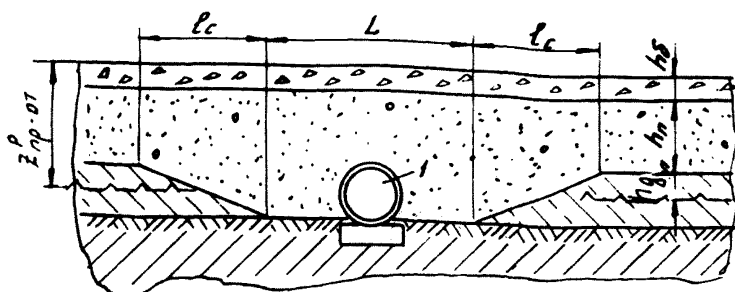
Схема устройства сопряжений насыпи из пучинистых грунтов на участке водопропускной трубы 1 при высоте насыпи менее 6 м
